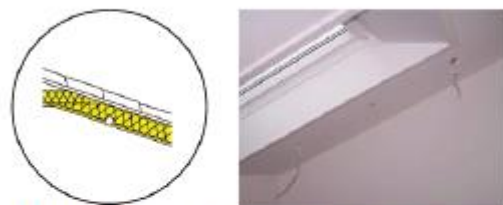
Vorbereitete Öffnungen für Einbauleuchten in einer Dachschräge
